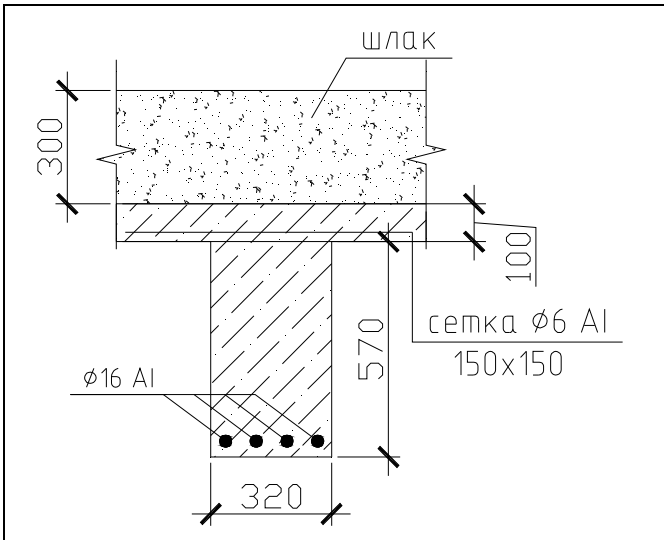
Главная балка ж/б перекрытия над пятым этажом в осях «3–8/А–В»
